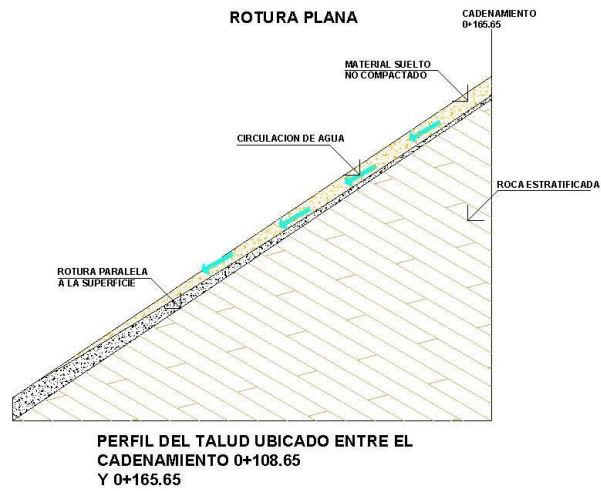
Esquema de rotura plana en el talud.
